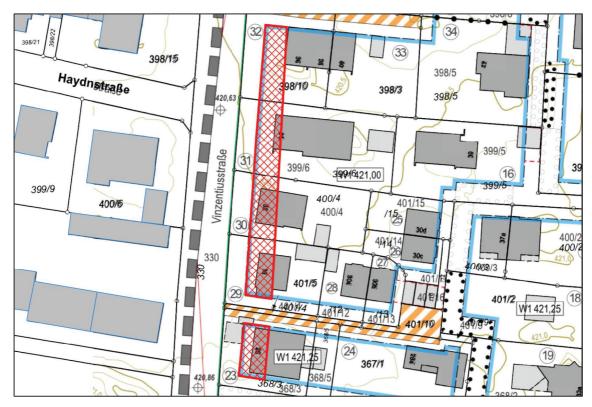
Lageplan mit Darstellung der von Schallschutz betroffenen Parzellen 23 und 29 – 32
